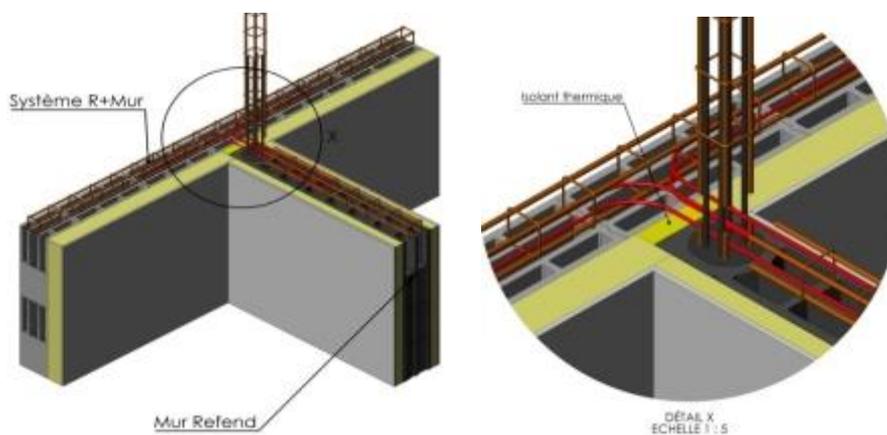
Jonction par juxtaposition d'un mur de refend/mur de façade en zones sismiques
